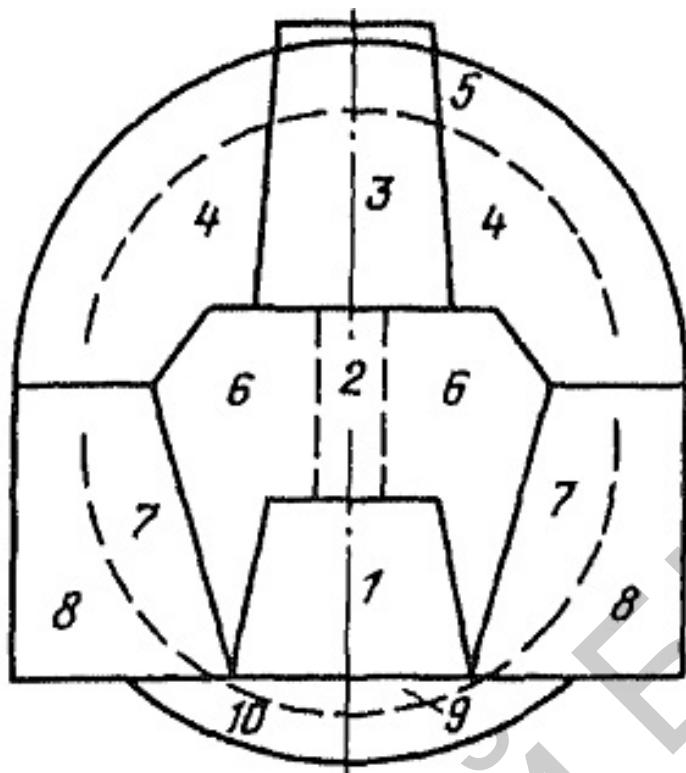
Раскрытие сечения тоннеля способом опертого свода
